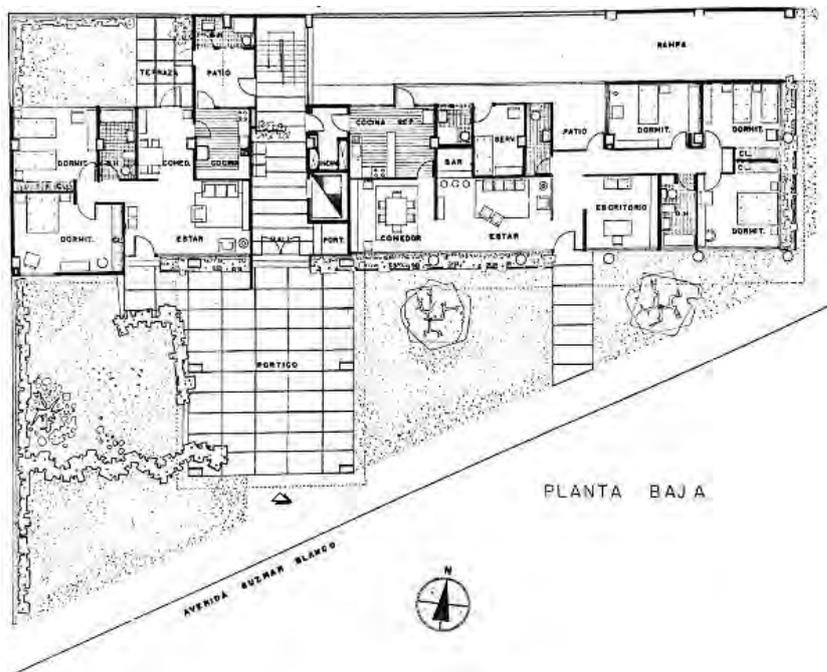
Planta urbana del Edificio Guzmán Blanco. Fuente: El Arquitecto Peruano n° 183-184.
